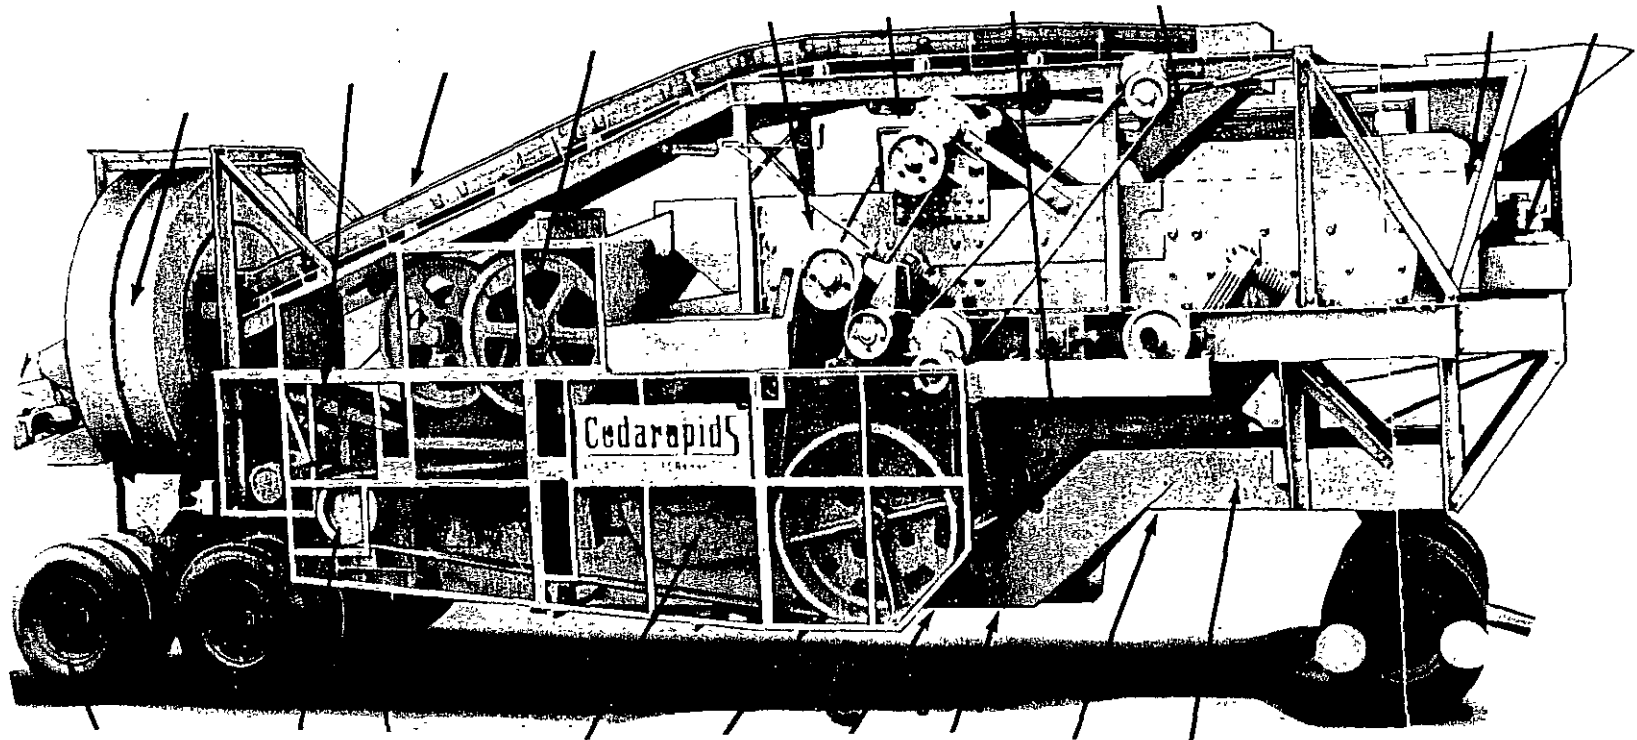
VISTA EXTERIOR DE CONJUNTO DE UNA PLANTA "DUAL" DE TRITURACION, EQUIPADA CON QUEBRADORA PRIMARIA DE QUIJADAS, TRITURADORA DE RODILLO DOBLE, CRIBA VIBRATORIA HORIZONTAL, Y ELEVADOR ROTATORIO DE CANGILONES.
